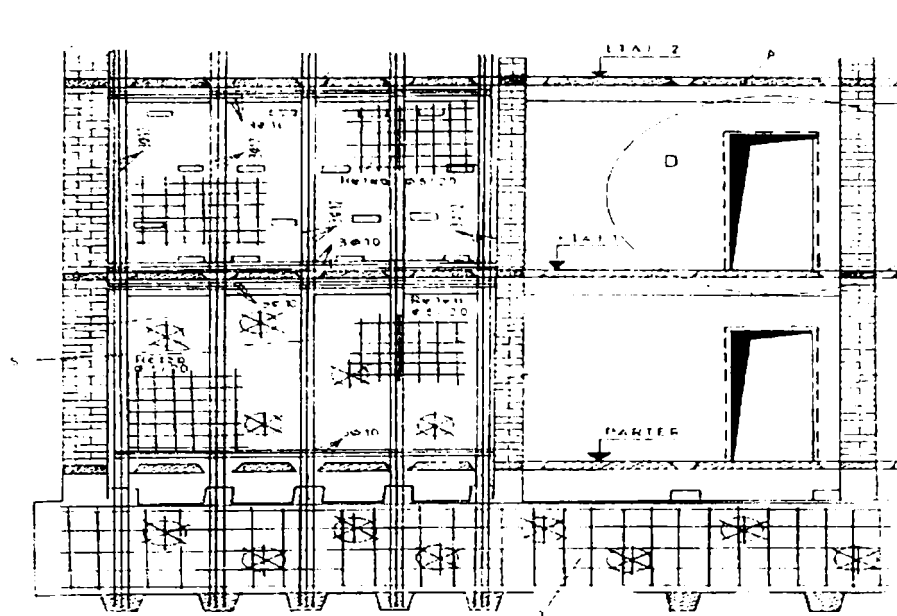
Armare camasiuala prin betonare ;1- fundatie ;2- pereti portanti ; 3- perete de camasuit ; 4- plasa armatura cu diam. min. 6/20 cm; 5- bare pentru asigurarea conlucrării pe verticala – min. 3 bare cu diam.12 mm .; 6- planseu ;7- goluri in placa .
